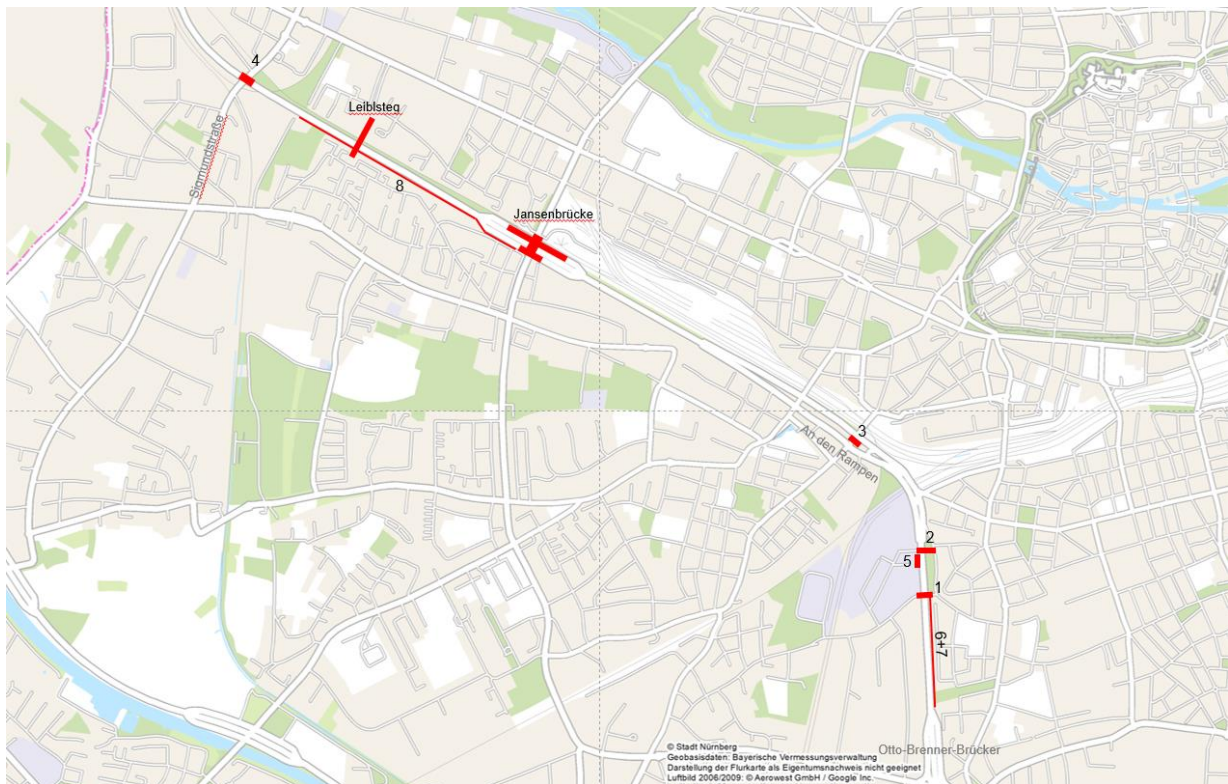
Lageplan Abschnitt West bis Tunnelende auf Höhe Otto-Brenner-Brücke
